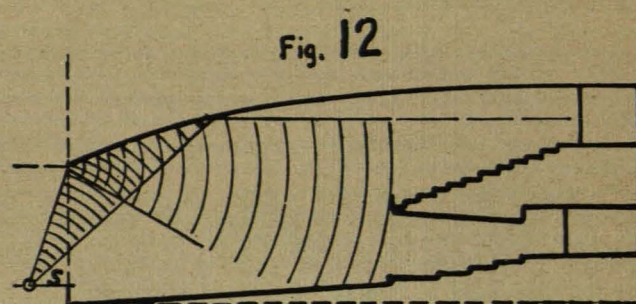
Sección de P. SABINE. Techo ligeramente parabólico y techo debajo del palco ligeramente inclinado hacia el fondo.
